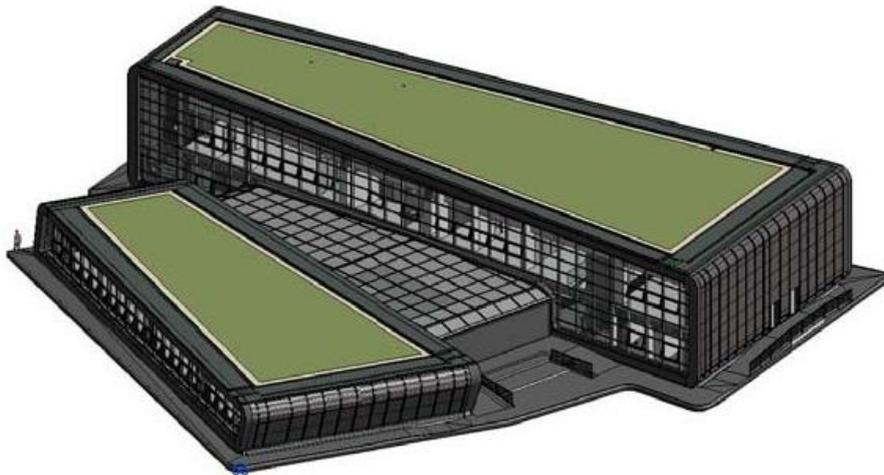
PCC - Vista prospettica dei fabbricati Nord Ovest
